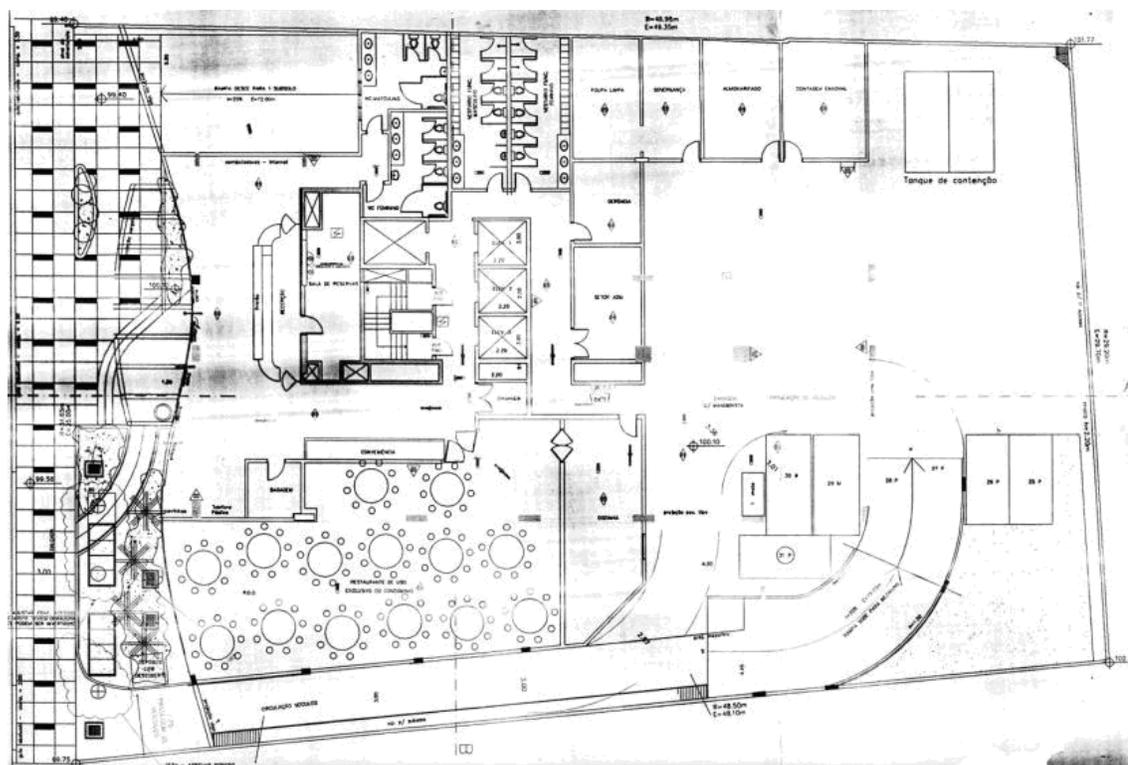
Planta do pavimento térreo da edificação analisada
